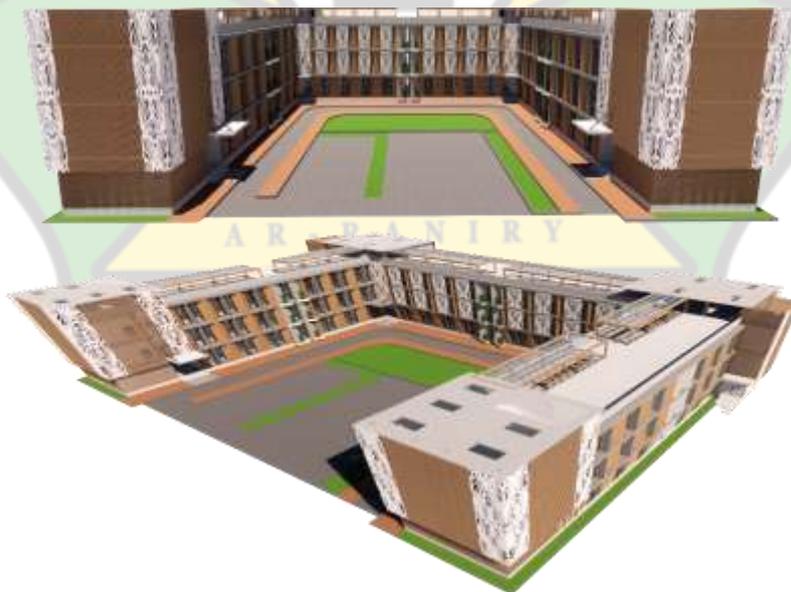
8 Gubahan Massa Dasar Bangunan
